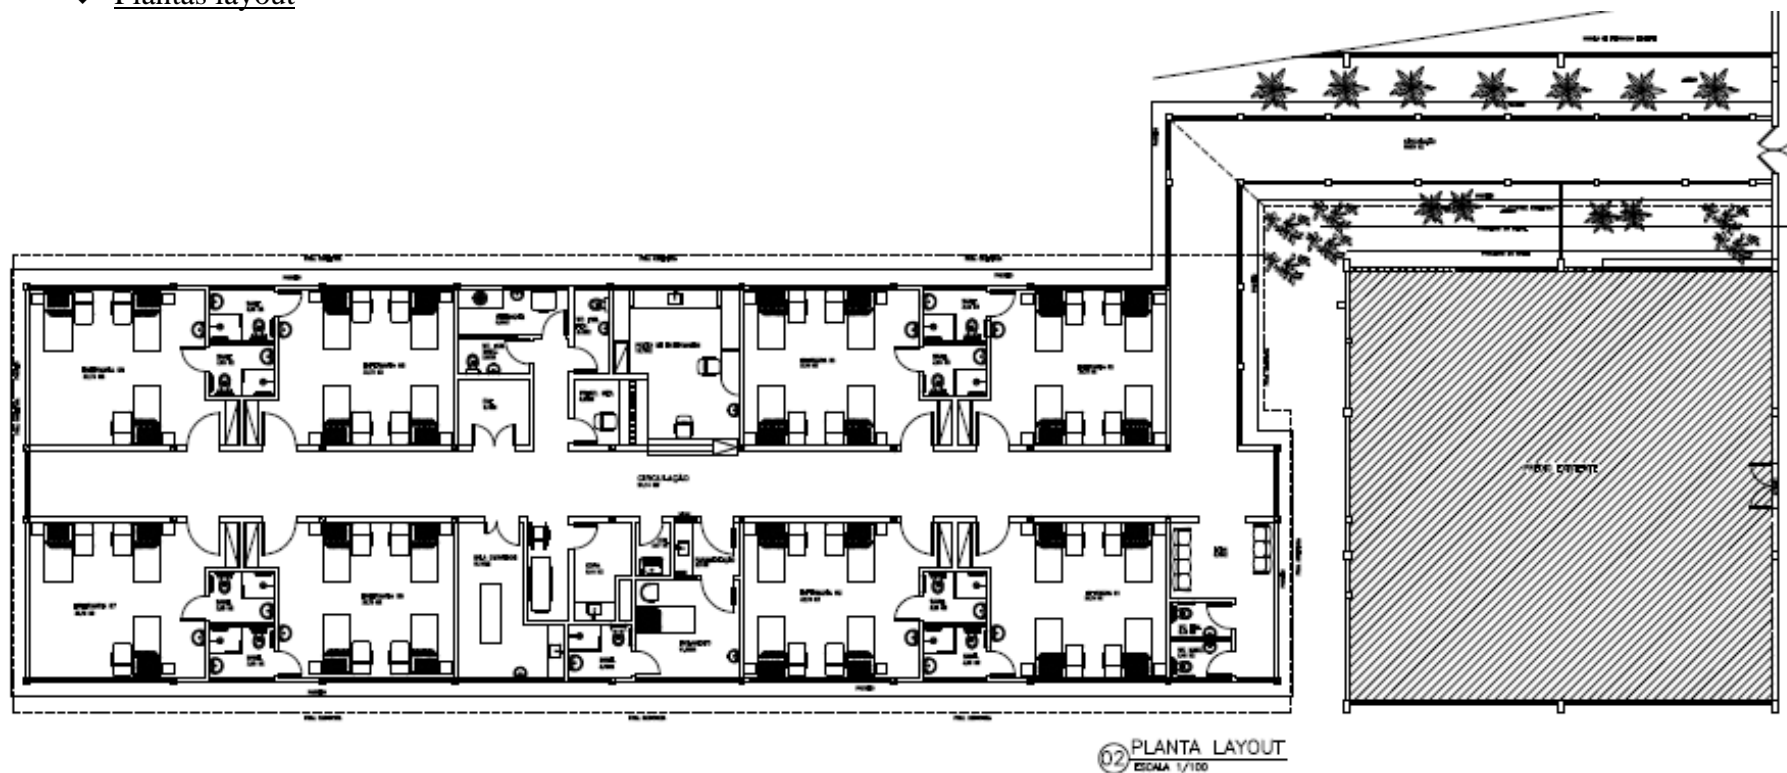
Planta Layout do Módulo de Internação Obstétrica do HCA
